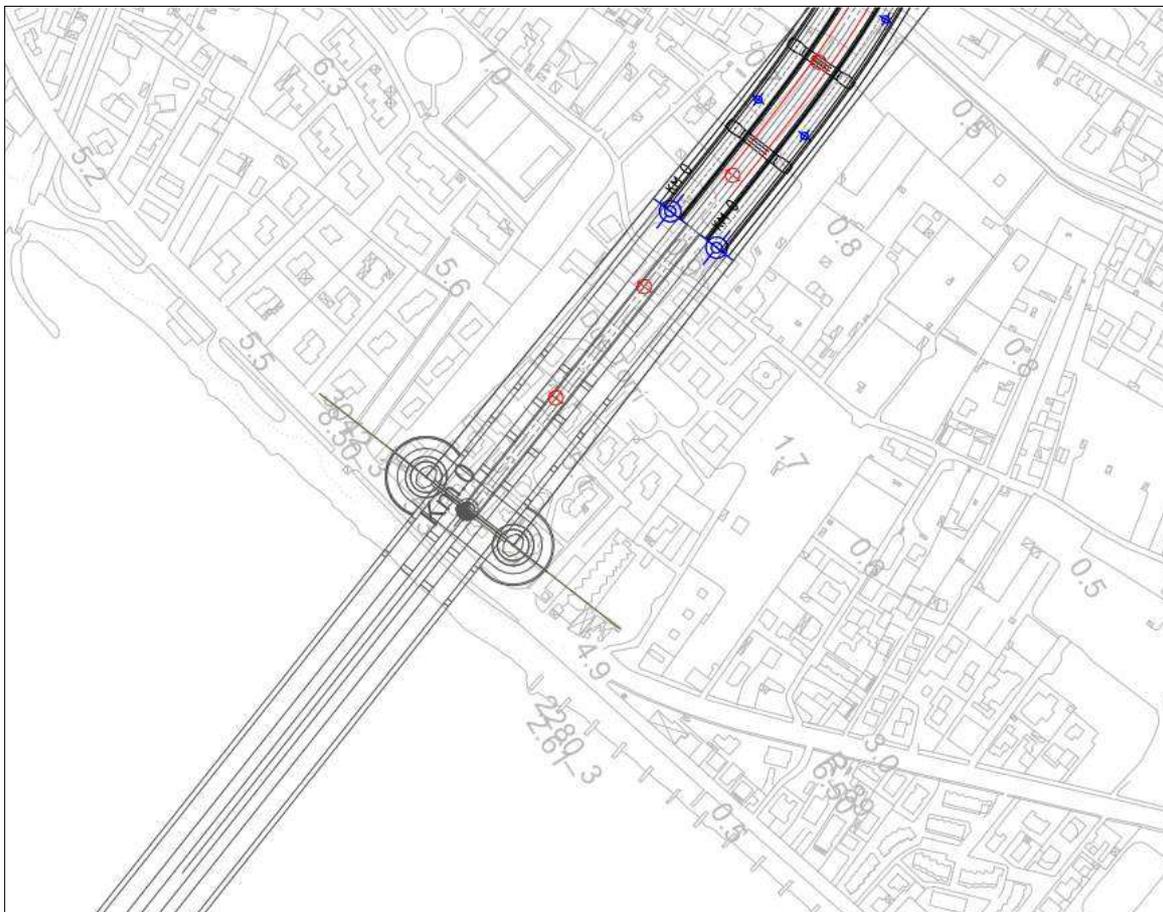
Posizione del pontile (freccia rossa) e del Ponte sullo Stretto
